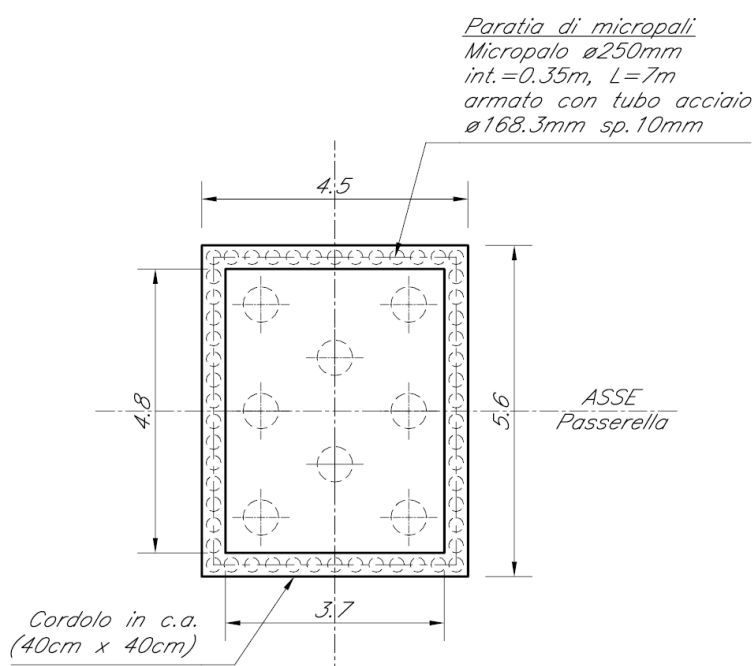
Paratia pila 2 – Vista in pianta [m]
